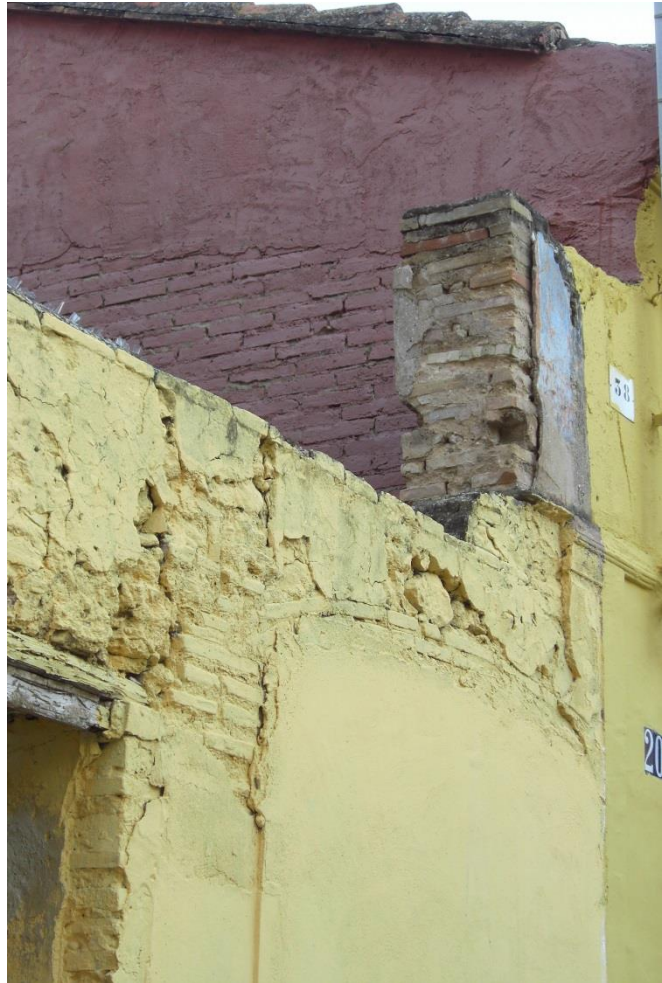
Muro de carga en fachada de ladrillo macizo, en C/ Padre Luis Navarro 206.
